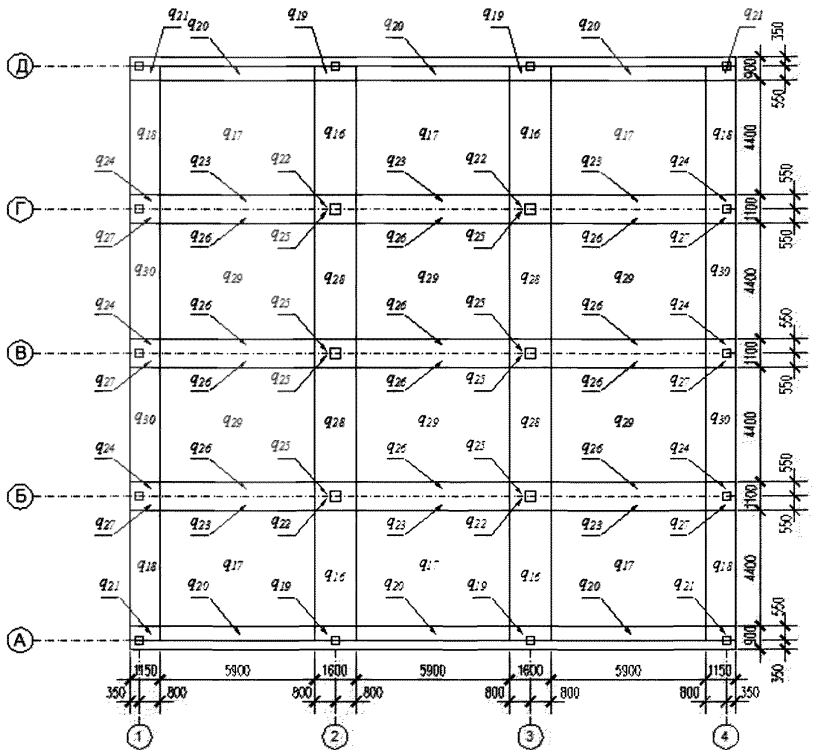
Схема приложения дополнительных вертикальных нагрузок от действия усилий обжатия вдоль цифровых осей
